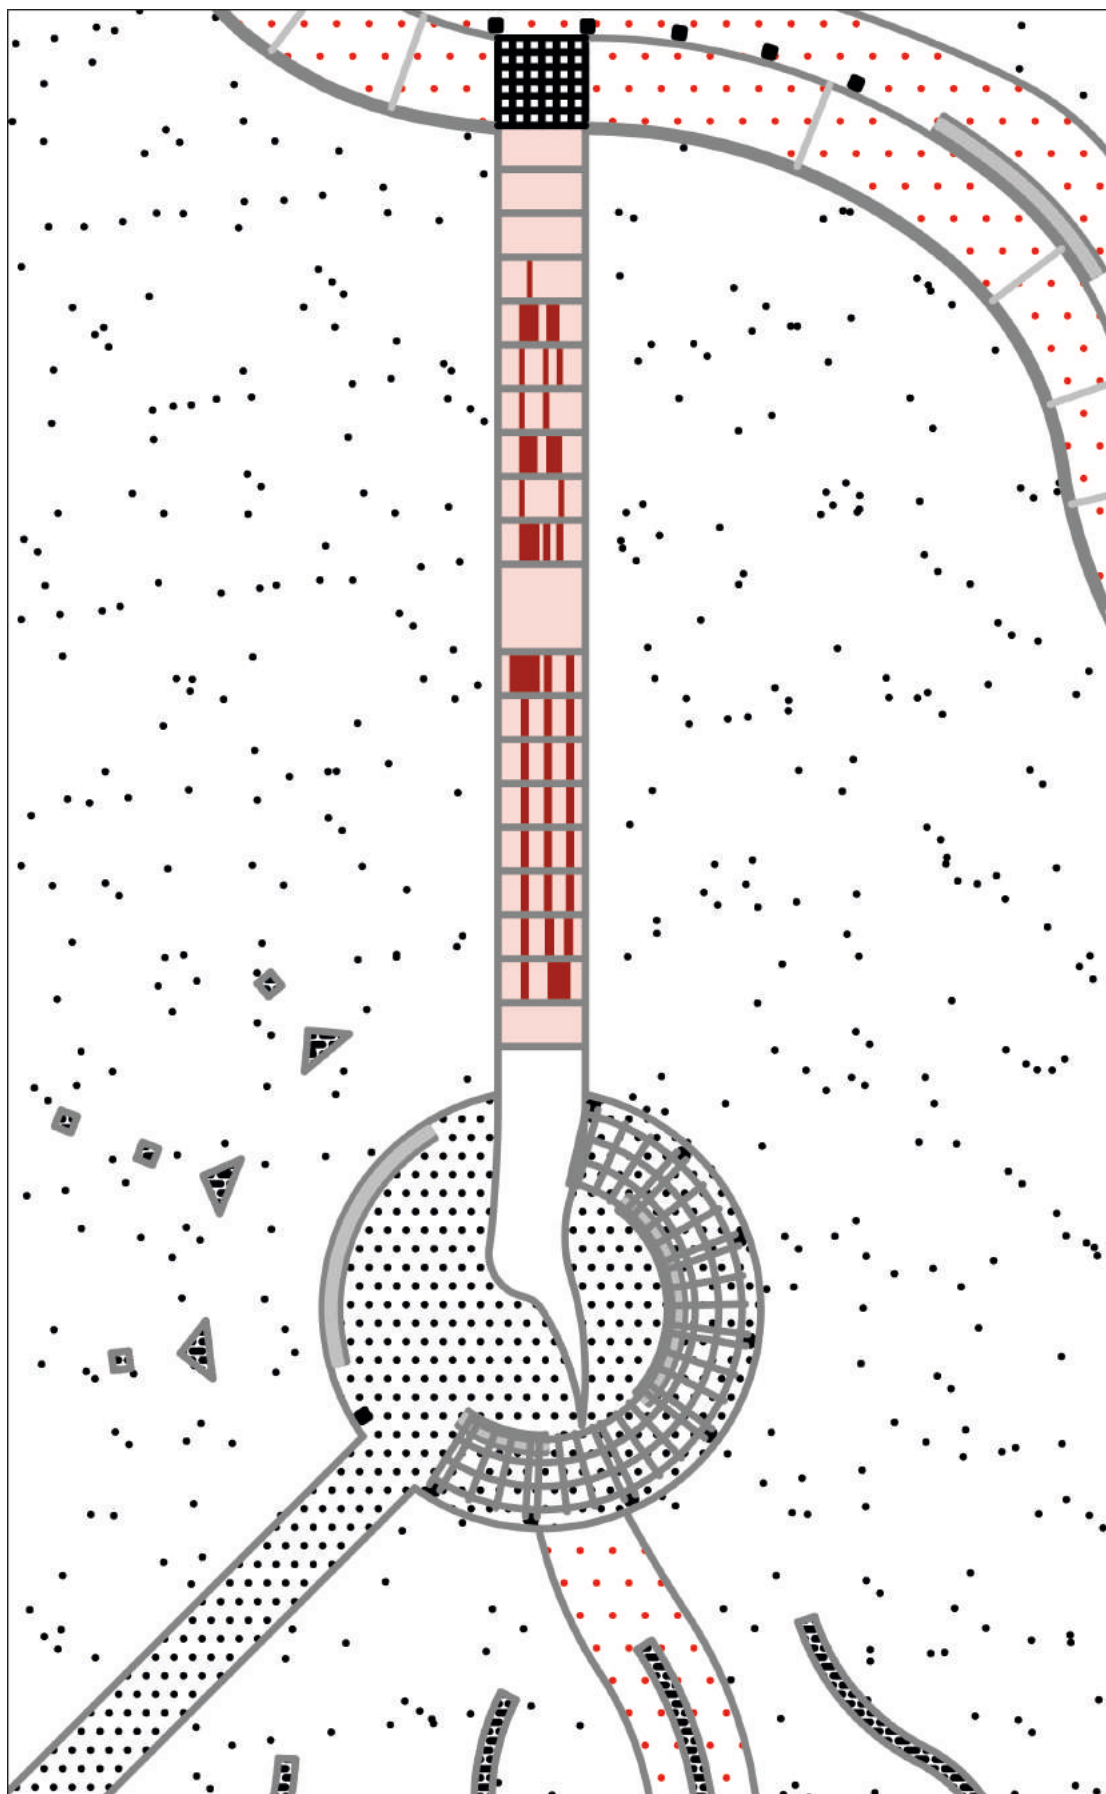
Pormenor das estadas “És tu” em planta Fonte: Foto de autor
